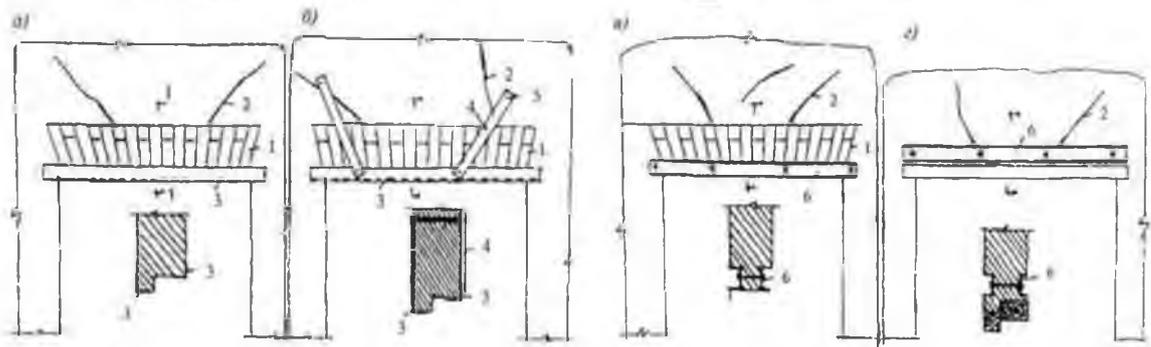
Приклади посилення перемичок цегляних стін а, б - шляхом підведення накладок з уголкової сталі; в, г - додатковими металевими перемичками з швелера: 1 - цегляна кладка; 2 - тріщини; 3 - накладки з куточків; 4 - смугові накладки; 5 - анкерні болти; 6 - накладки з швелера
